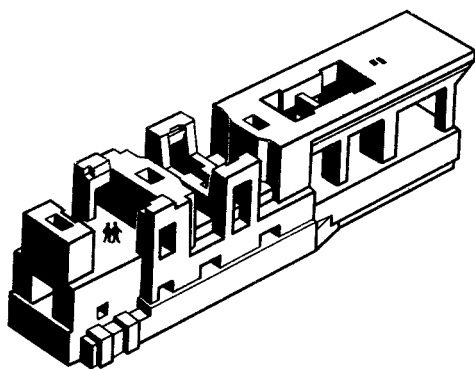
Фундамент турбины К-500-60/1500 ХТЗ
